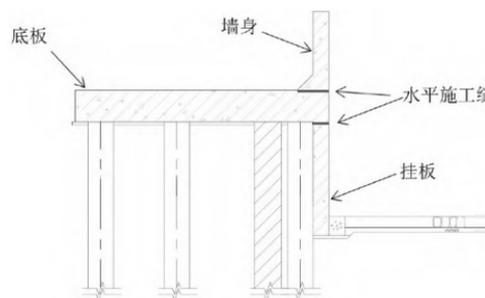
钢筋混凝土挡墙常规做法施工缝设置示意图
